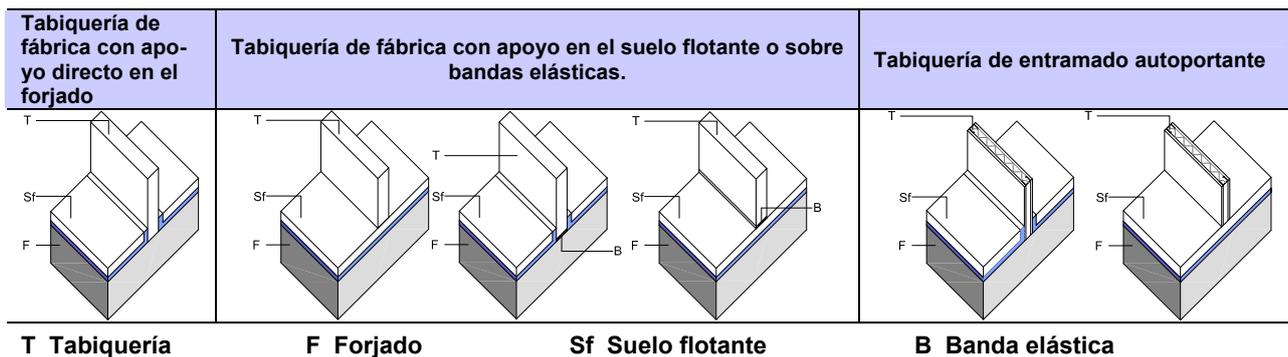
Tipos de tabiquería recogidos en el DB HR.
